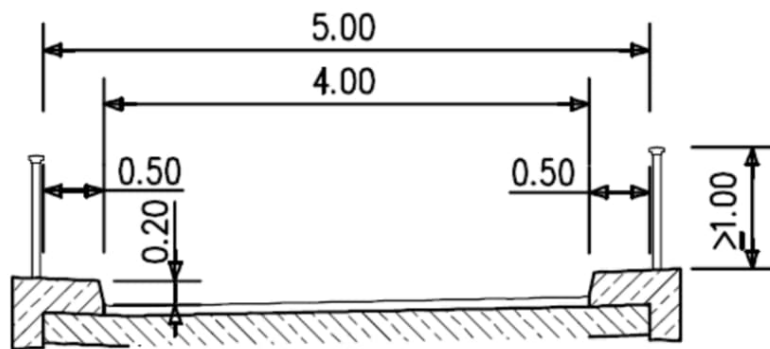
Querschnitt des Überführungsbauwerks BW 02 Burgbergweg (RE-ING, Bild 2.1.1)
